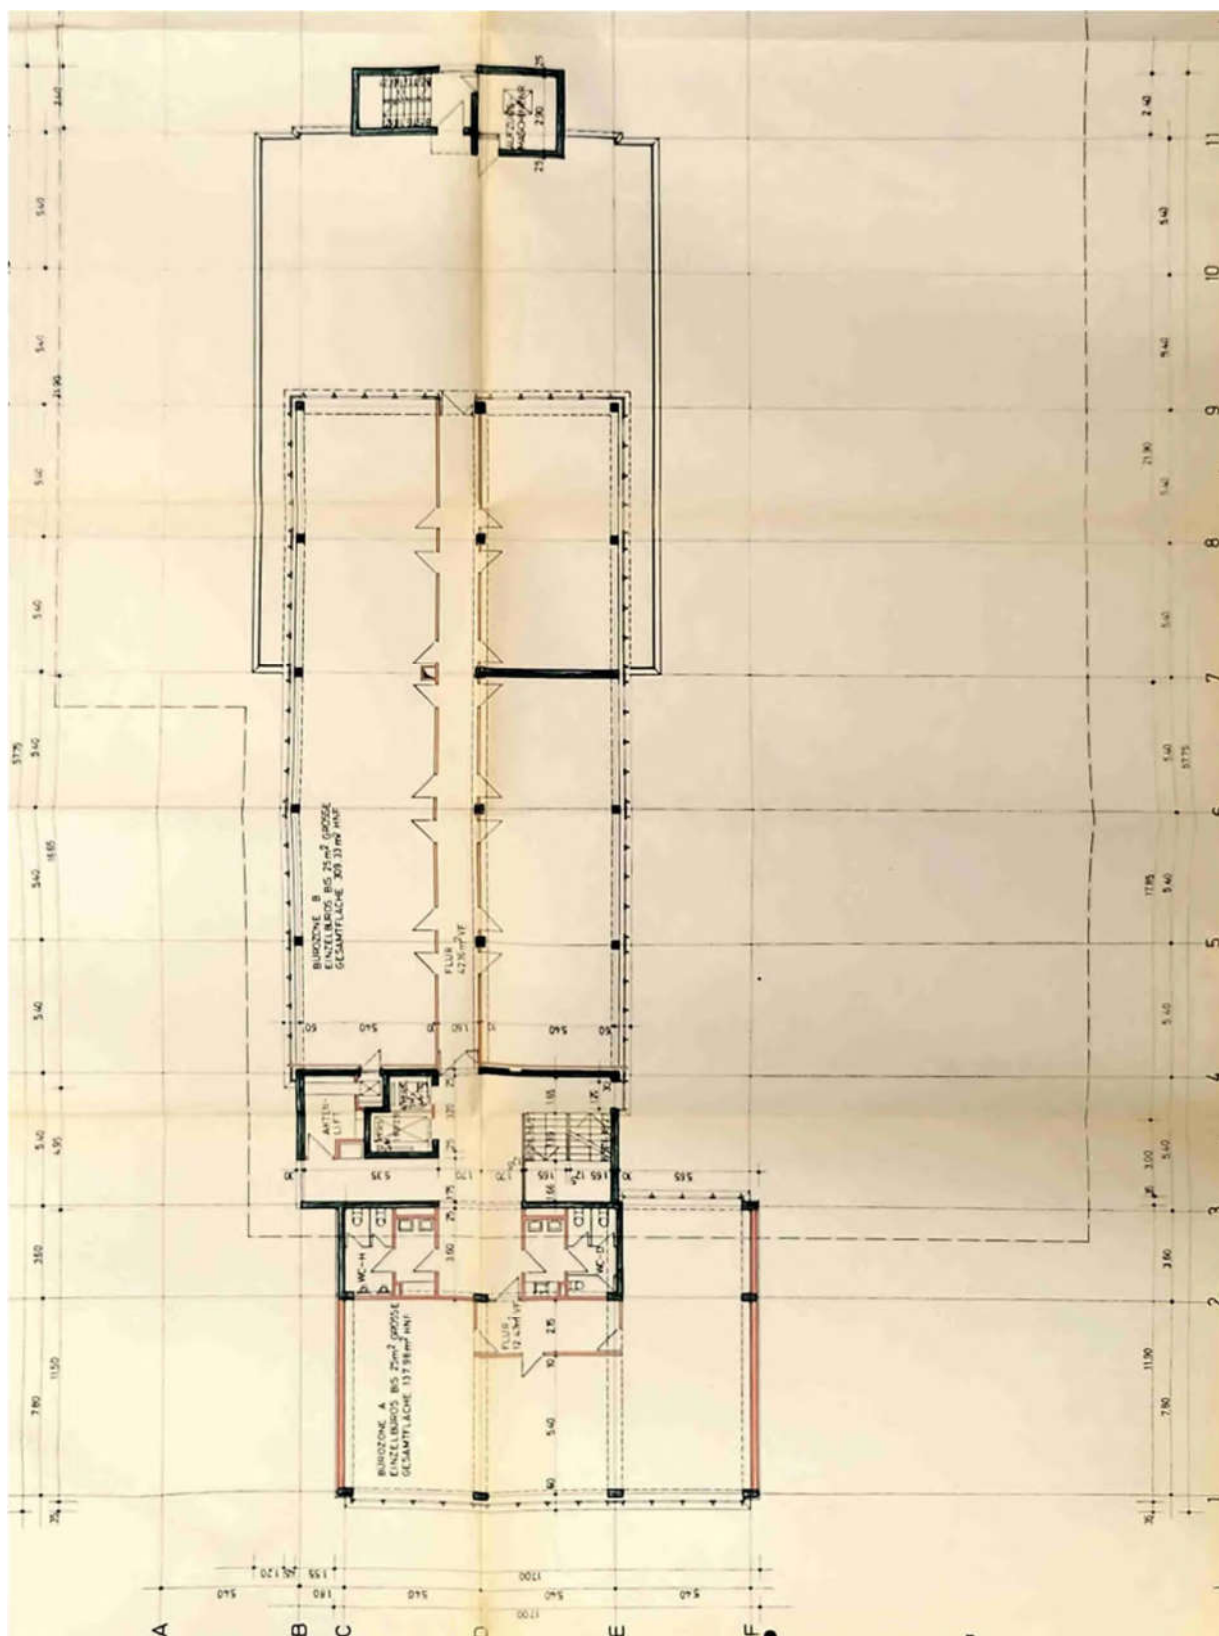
Grundriss 4. Obergeschoss
